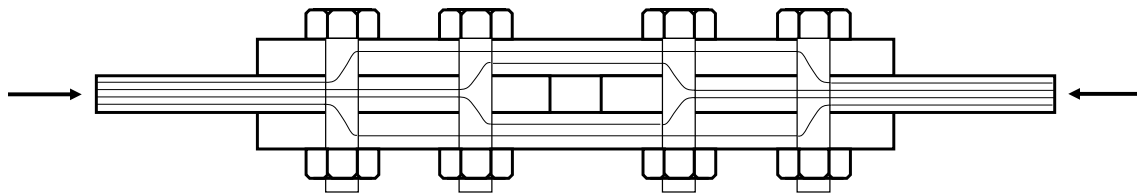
Líneas de transmisión de esfuerzos en una unión bearing type.
